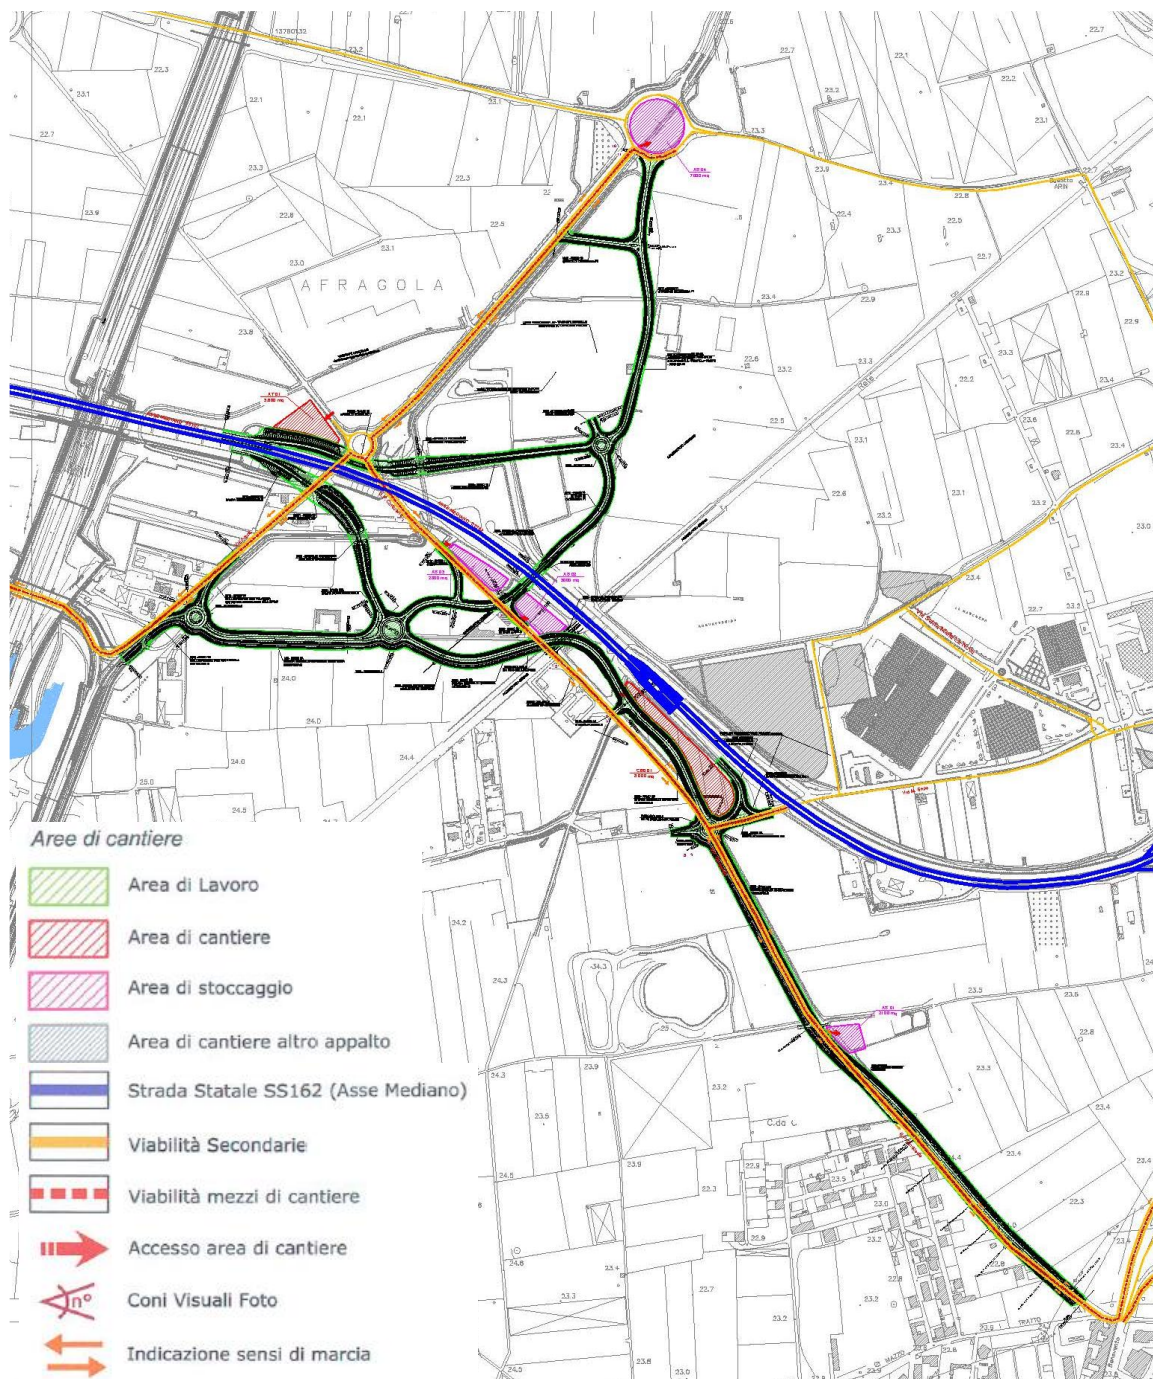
Tracciato di progetto e Aree di Cantiere
